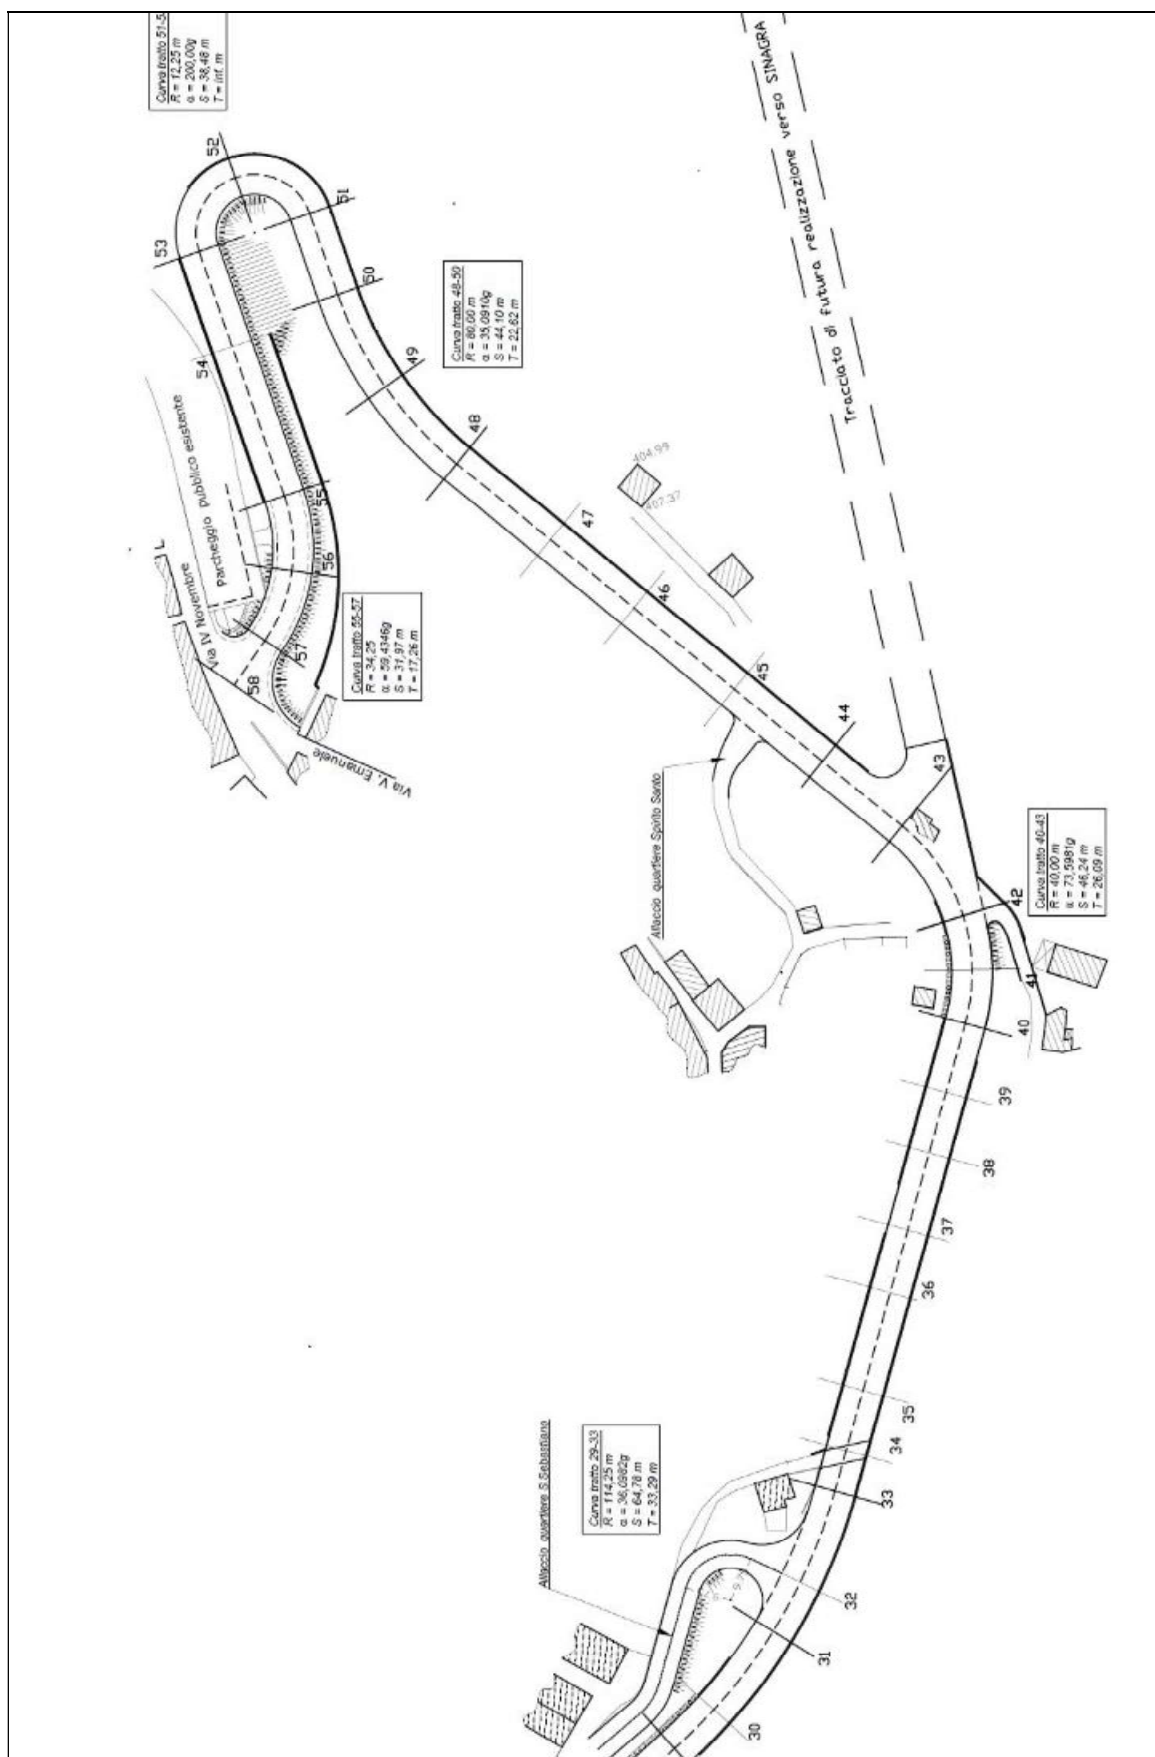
Planimetria del tracciato stradale con ubicazione delle sezioni (dalla n°30 alla n°58).
